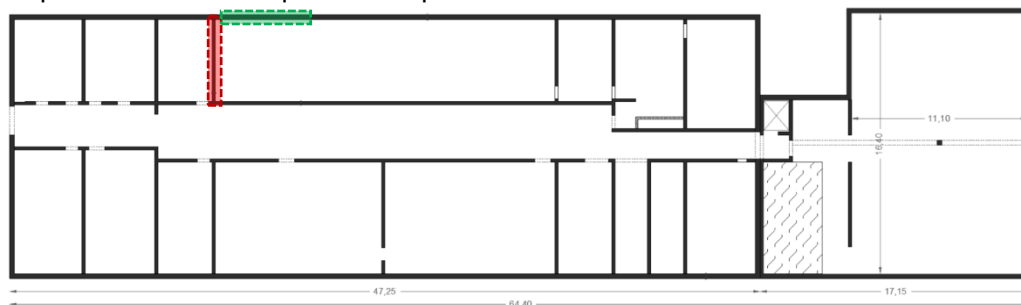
Bâti 3 - Plan de principe du sous-sol localisant les DDC estimée au droit d'un refend (en rouge) et d'une façade (en vert)
